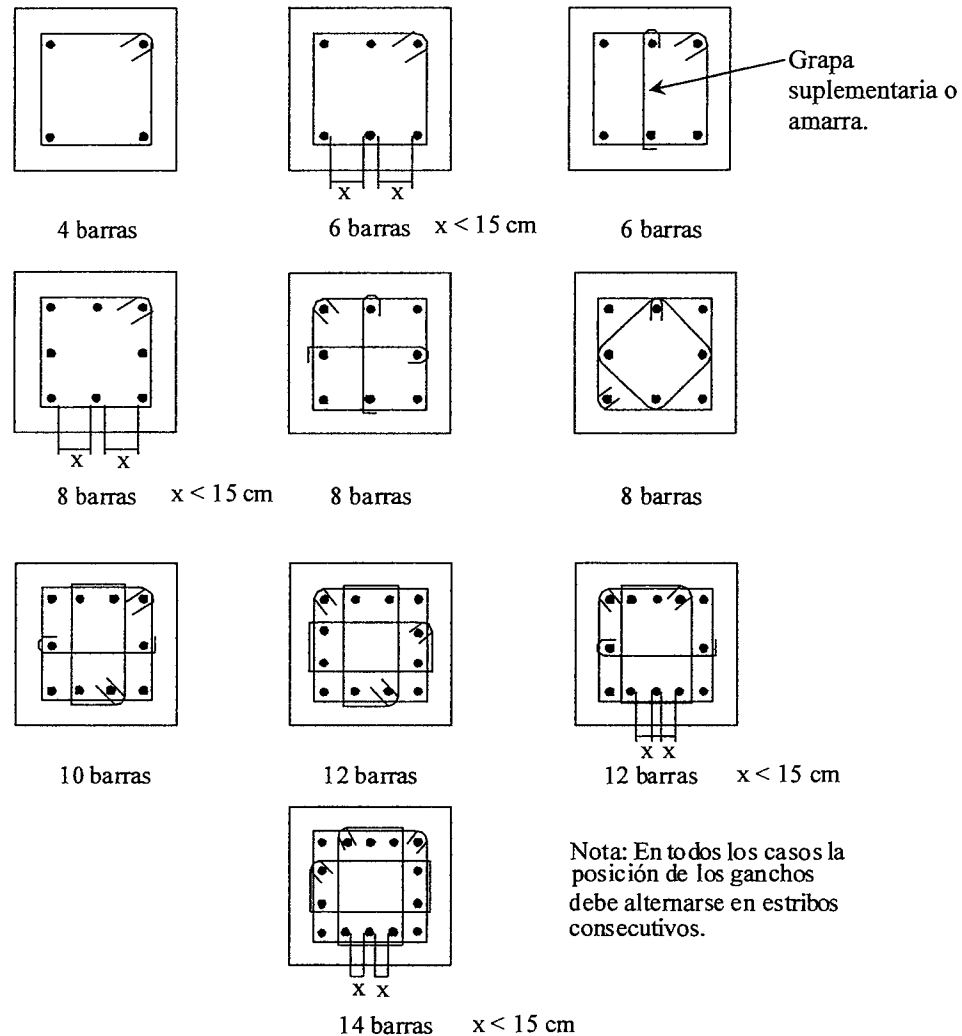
Arreglo del refuerzo en columnas cuadradas.
